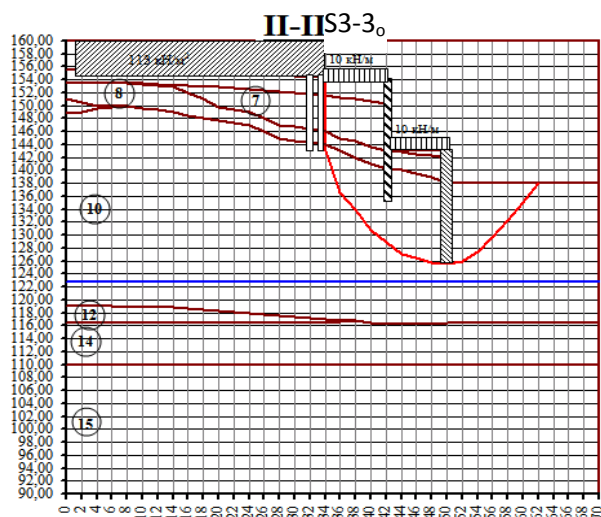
Расчетная схема устойчивости подпорных стен для сечения S3-3_o
